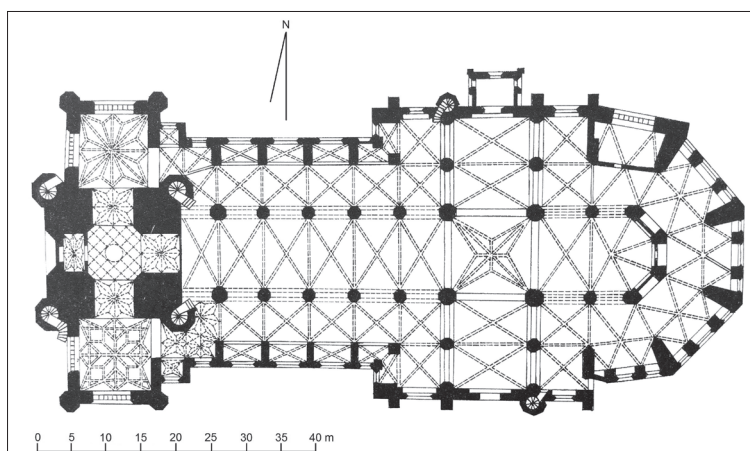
Stralsund St. Marien, Grundriss
